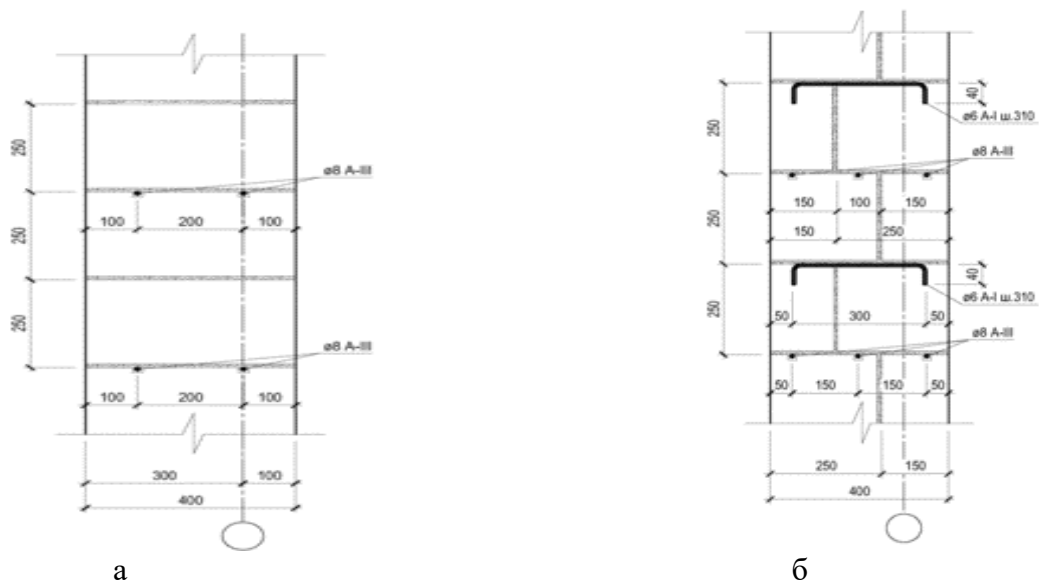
Фрагменты перевязки и армирования пенобетонных блоков для стен толщиной 400 мм: а – однослойная кладка; б – двухслойная кладка.
